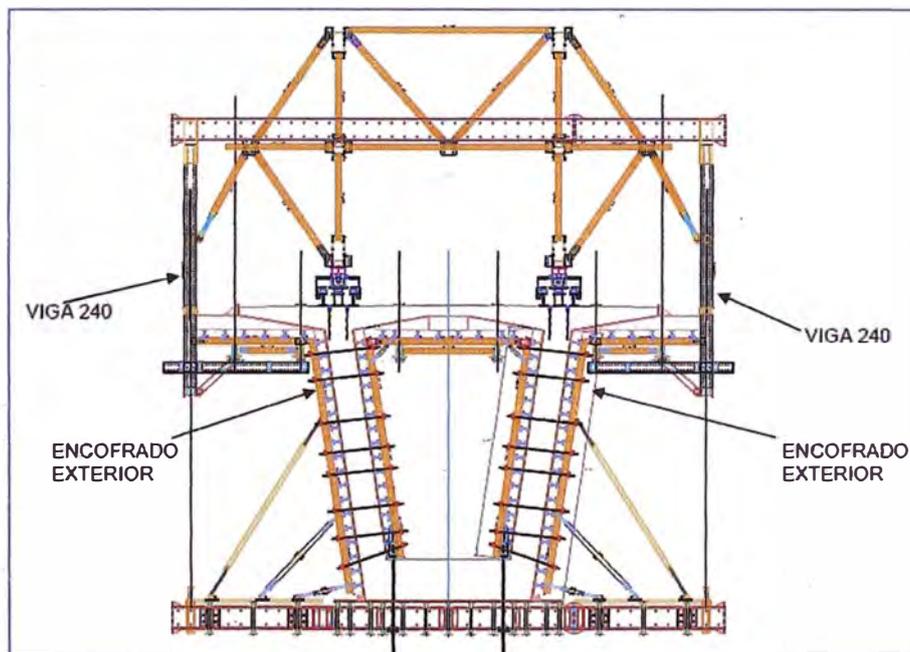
Vista sección encofrado exterior - Fuente: Elaboración Propia
